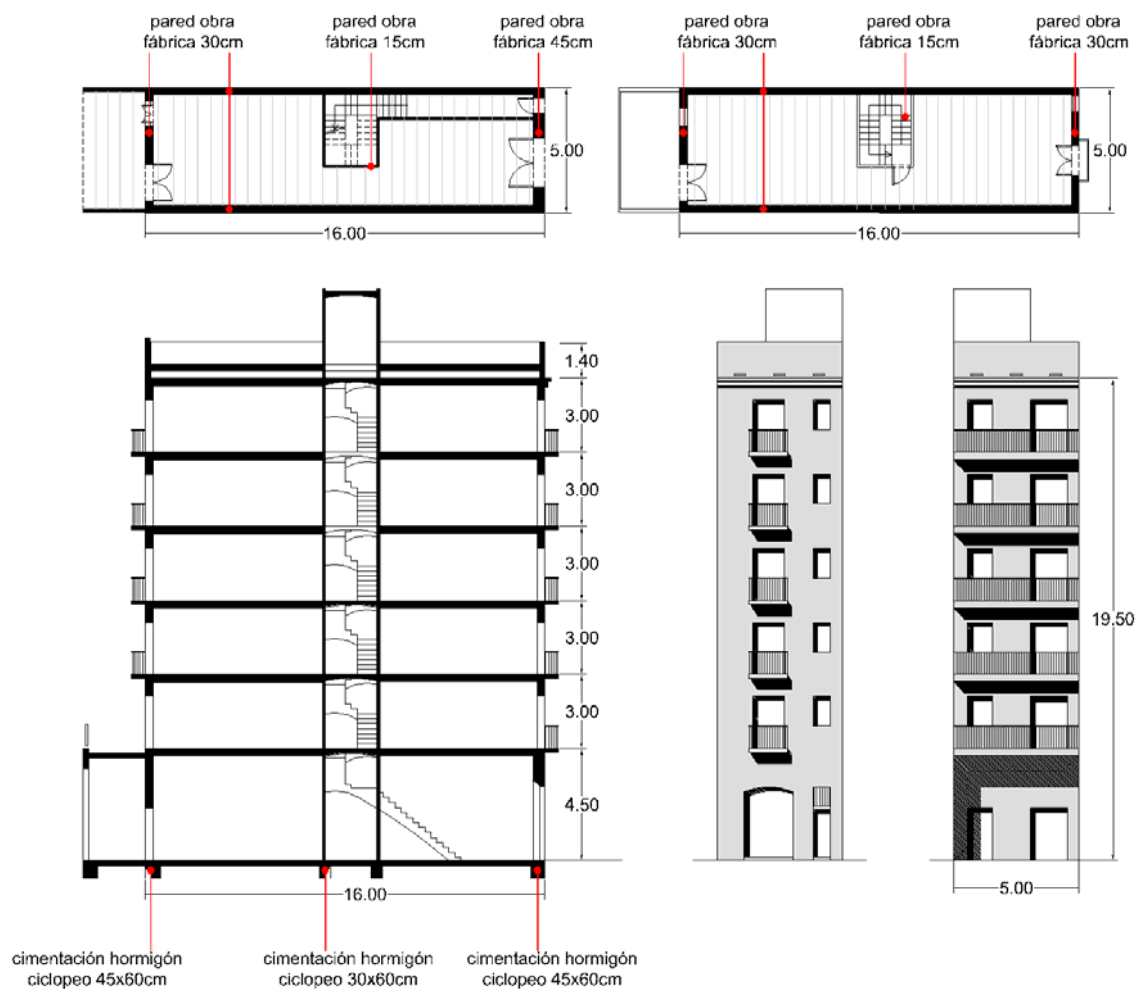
c Plantas, alzados y sección del modelo I.5
